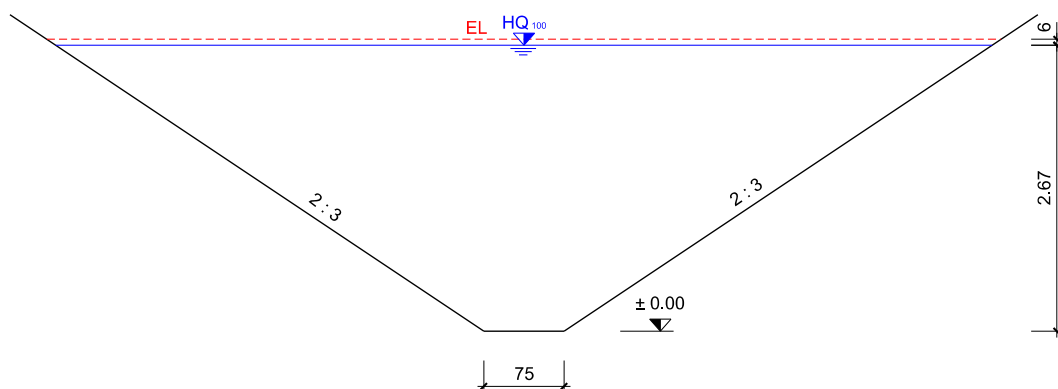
Bestehender Bachquerschnitt (Unterwasser Brücke Mühlackerstrasse)
